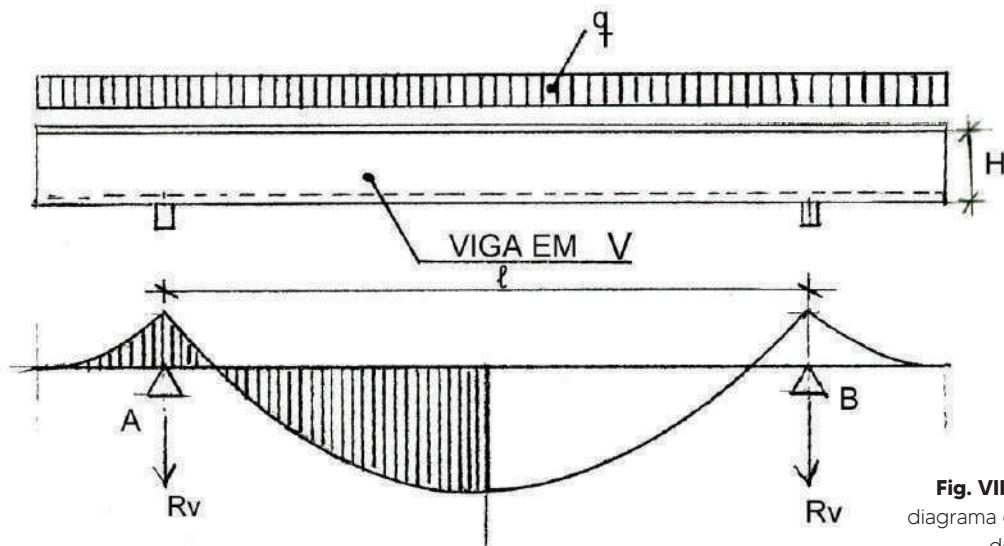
Cargas e diagrama de momentos de viga V. (*-5).
